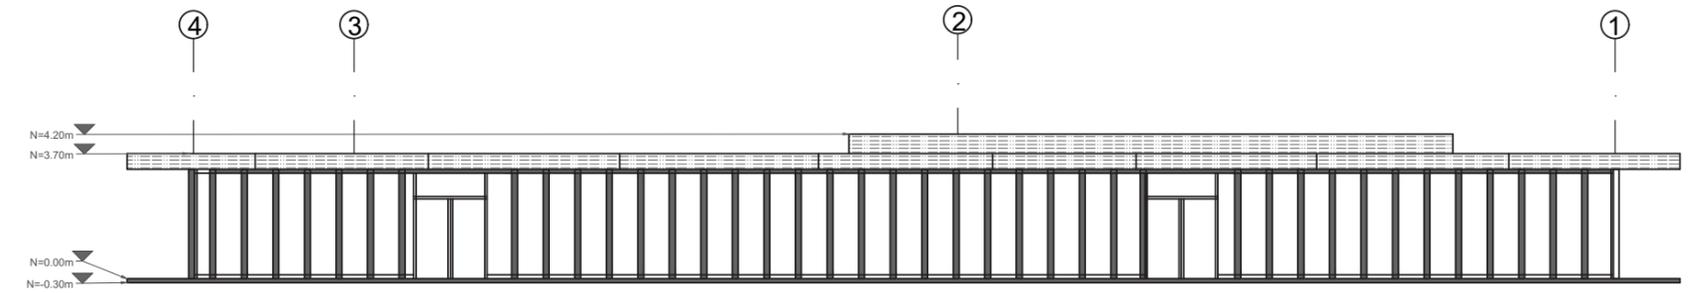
PLANIMETRÍA\_ELEVACIÓN POSTERIOR
